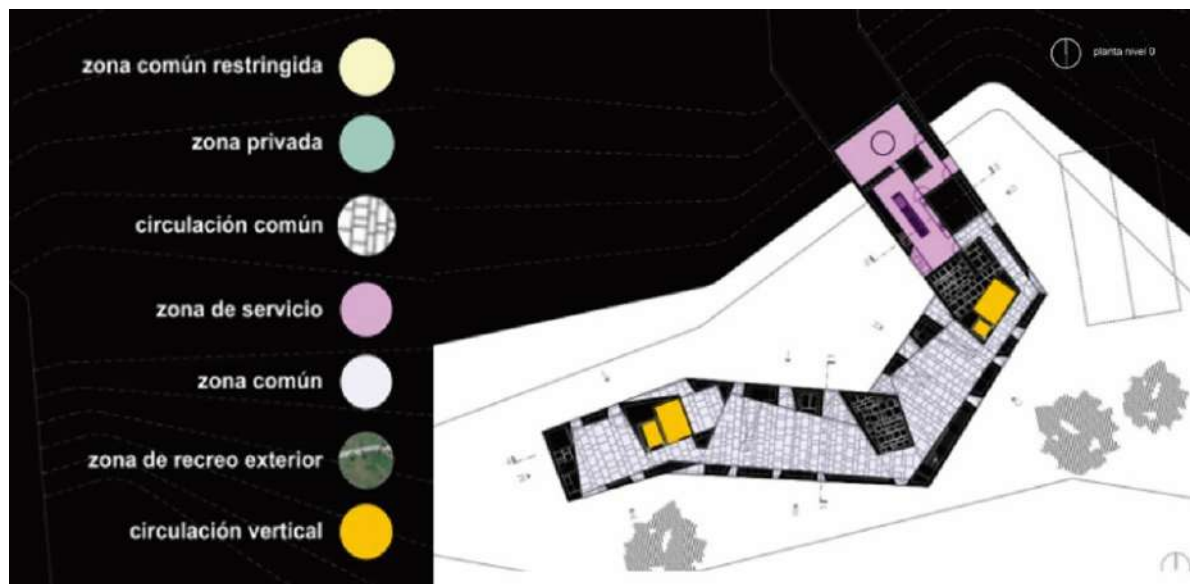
Planta baja. Zonificación. Fuente: Telegra.ph
